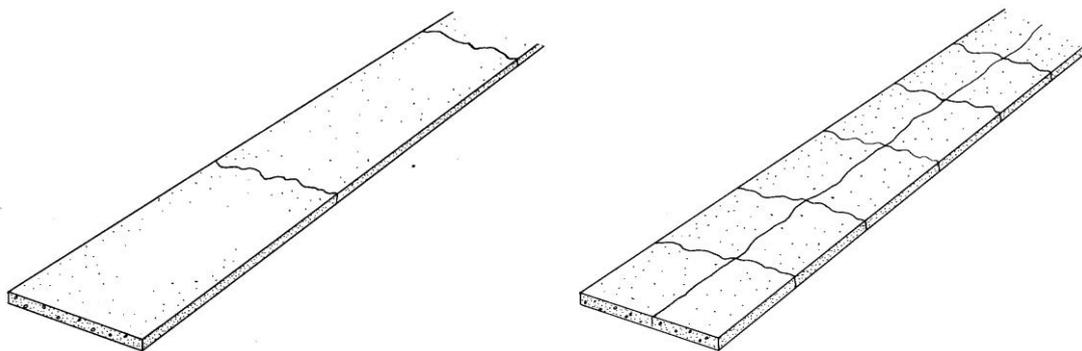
Fissuration "naturelle" d'un revêtement en béton de ciment sans joint ; extrait de (1)
